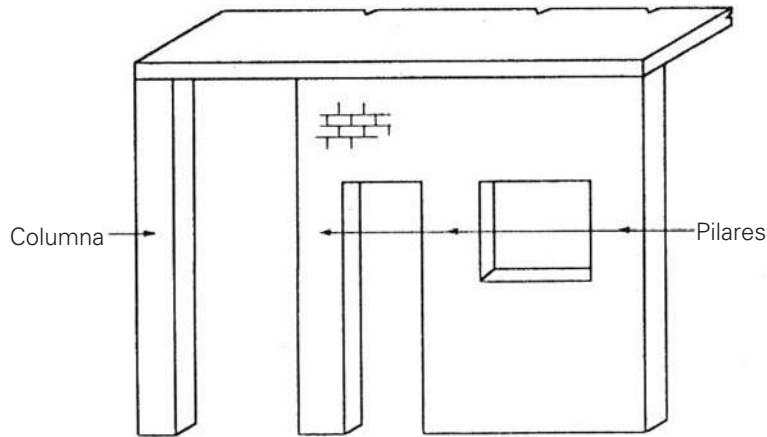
Definición de columna y pilar. (Schneider, R., y Dickey, W., 1994).
